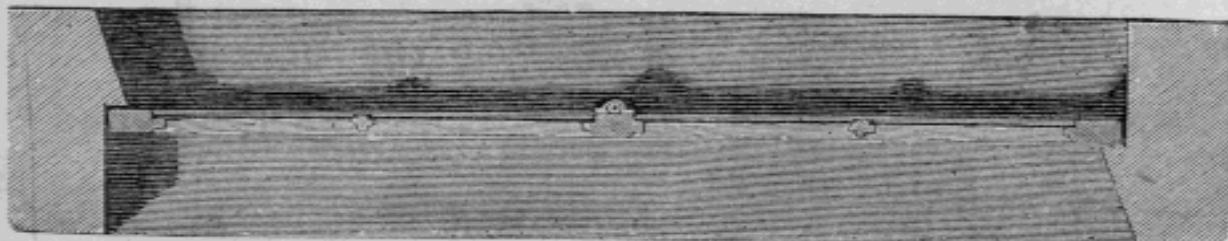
Plan, en coupe horizontale, d'une fenêtre à pivot.
